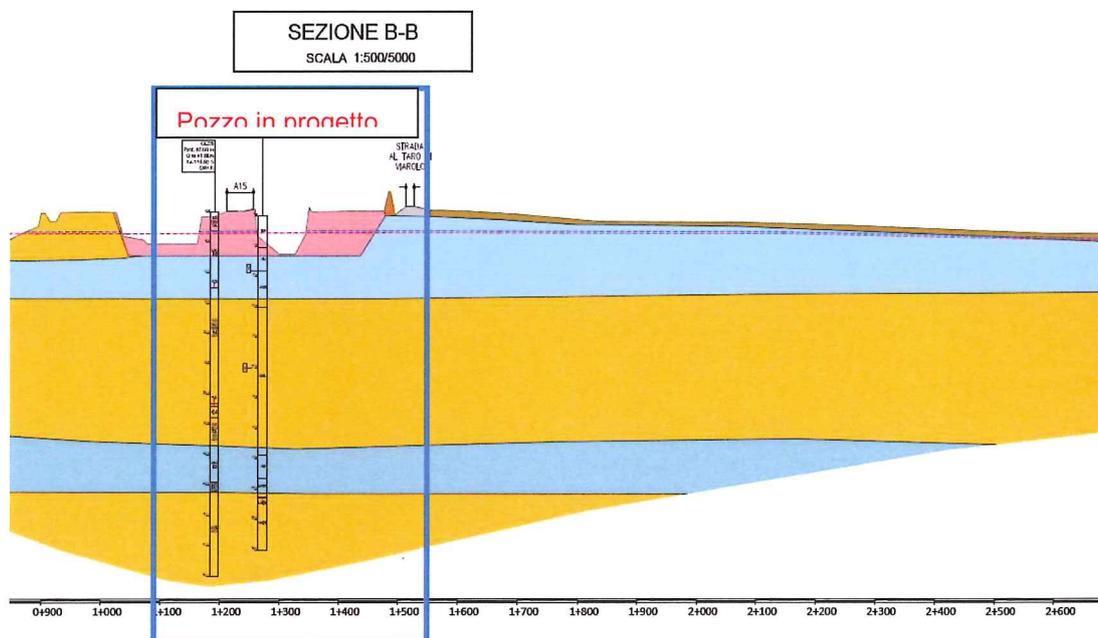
Sezione B-B tratta dal progetto esecutivo
